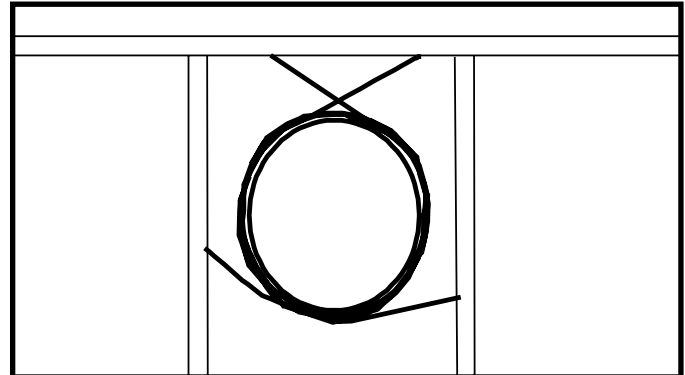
Sujeción de las secciones horizontales del tubo de escape
